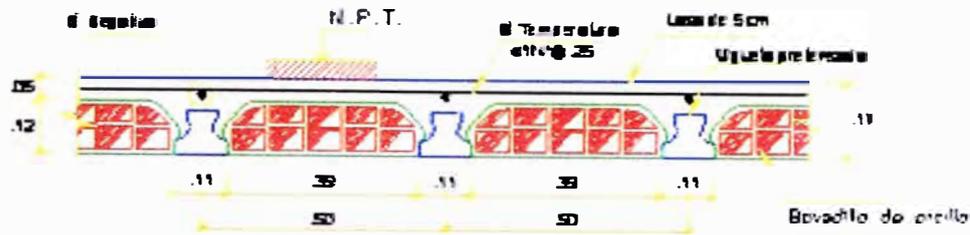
Detalle de losa aligerada con viguetas pretensadas Firth
